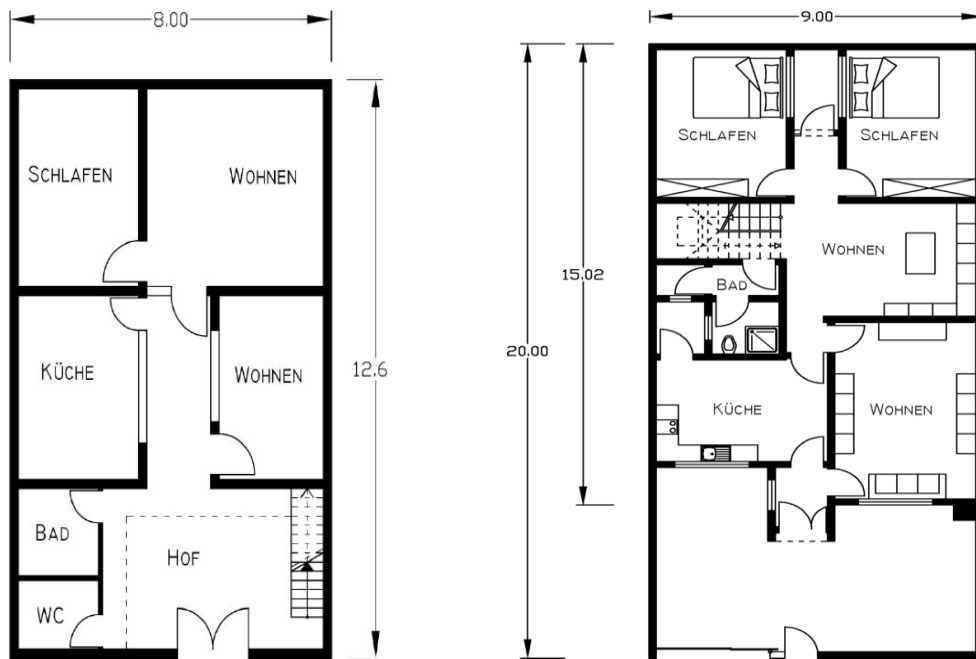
Grundriss eines traditionellen Hauses (links)¹¹⁹ und eines modernen Hofhauses (rechts)¹²⁰
